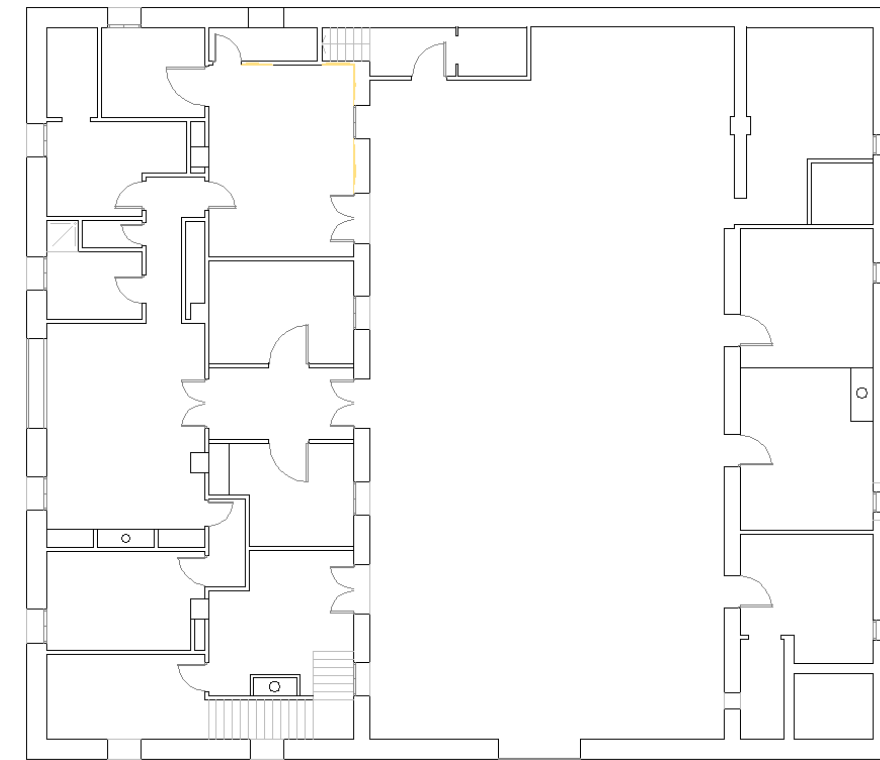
Plano planta baja con lesión mapeada (Fuente propia)
